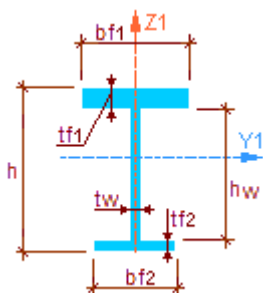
Схема профиля Двутавр сварной несимметричный
